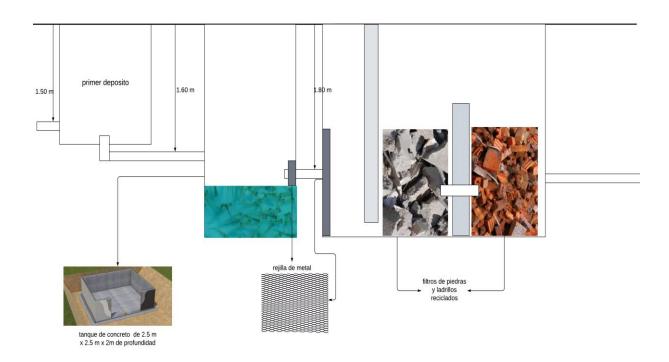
Esquema de planta de tratamiento convencional.
